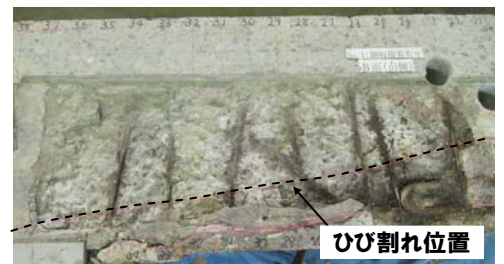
斜めひび割れ発生位置(No.1試験体)
